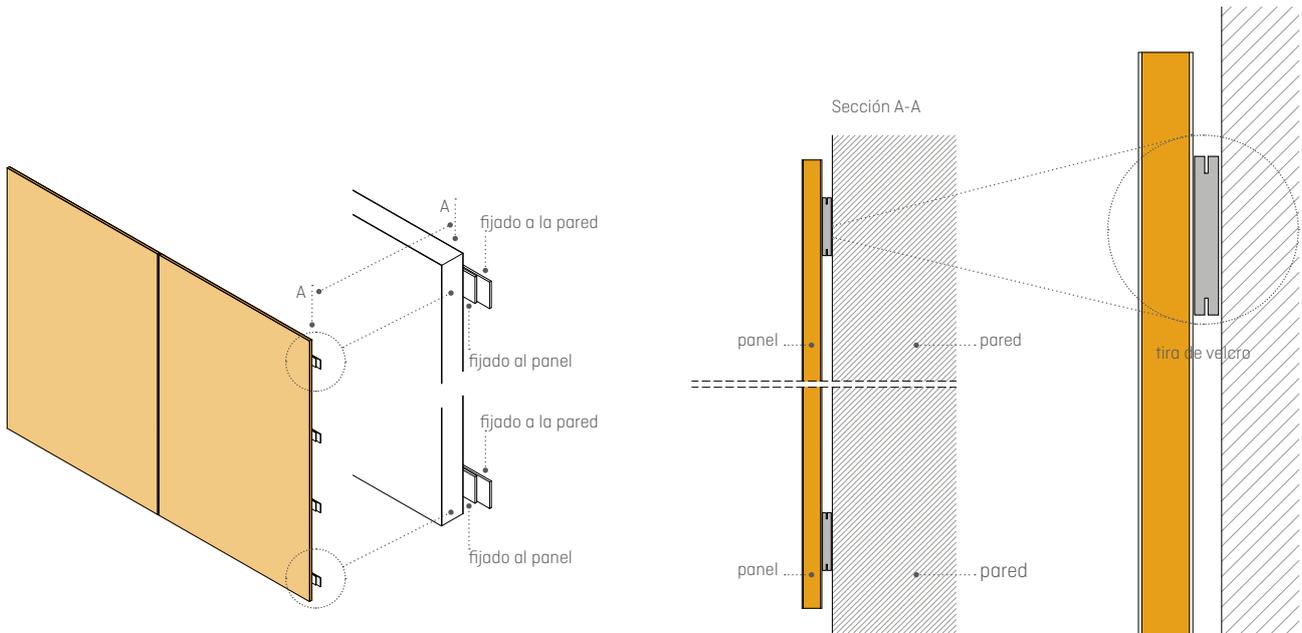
Detalle constructivo para la aplicación de paneles con velcro
